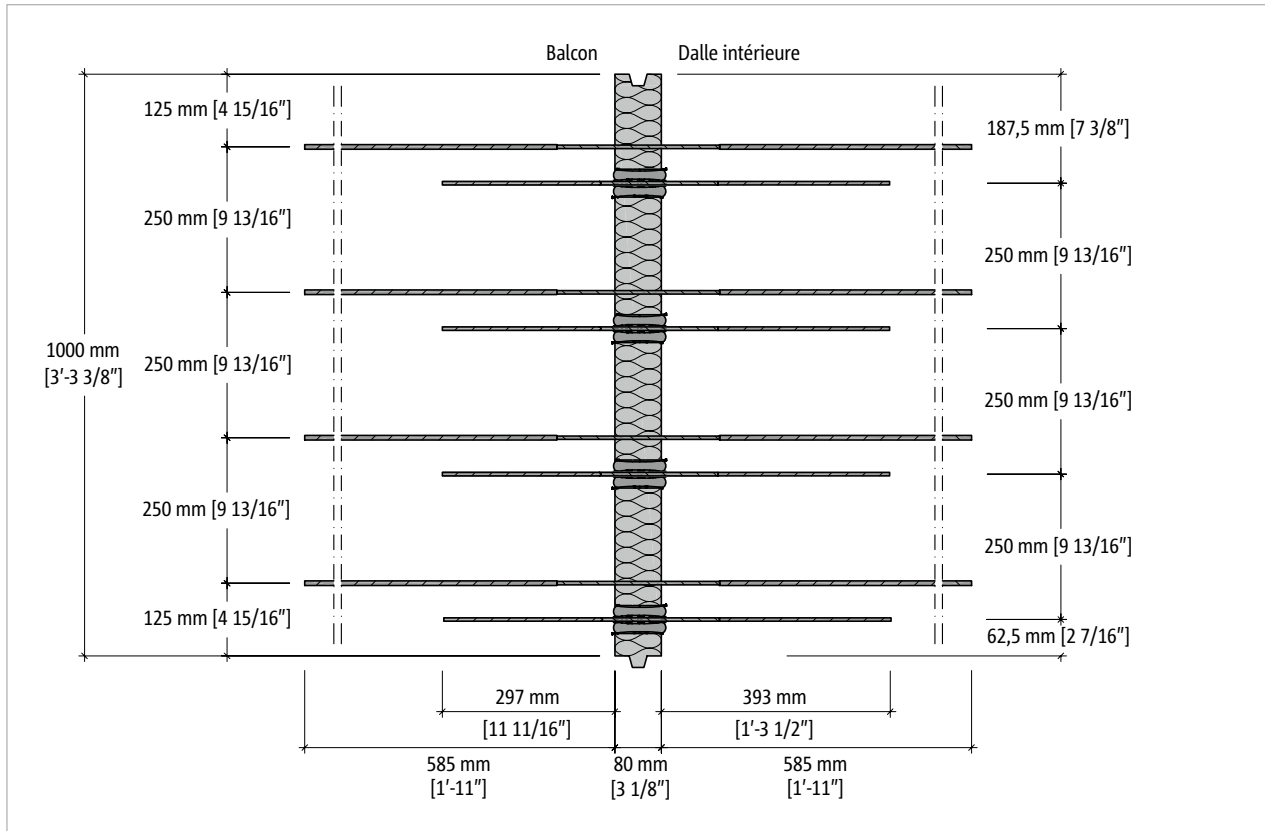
Schöck Isokorb® T Type CK-M1-V1 : vue en plan du produit
